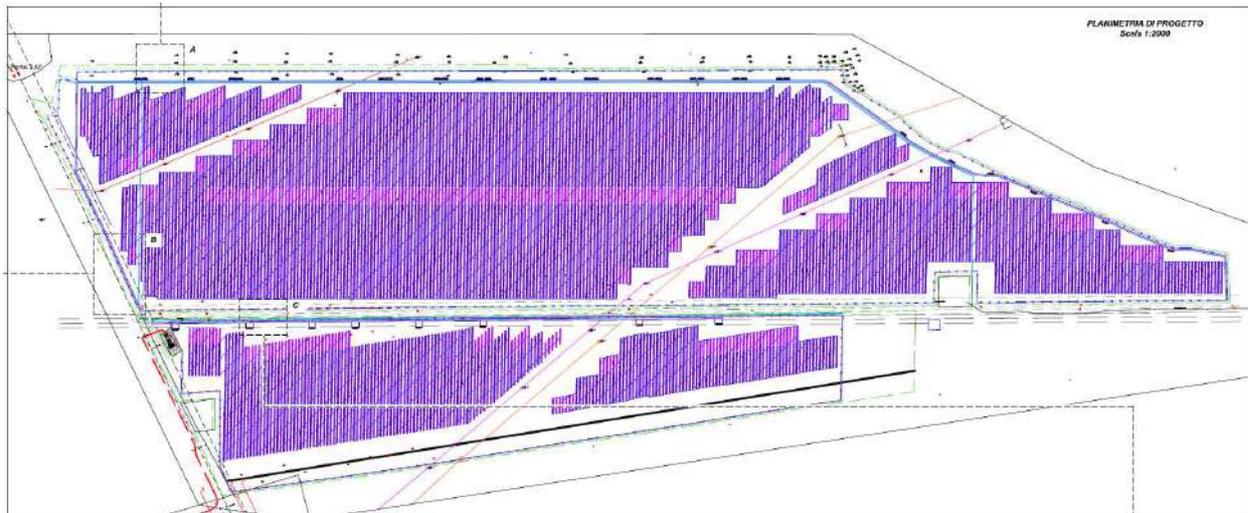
Planimetria interventi di mitigazione di progetto (stralcio da Tavola T22 – Opere di mitigazione)
